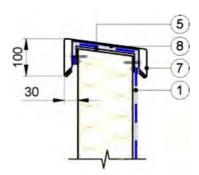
Примыкание к парапетной стене высотой менее 500 мм с использованием фартука (см. рис.13) Металлический отлив укладывается на крепежные элементы и крепится к парапету с помощью саморезов. Кровельный ковер заводится на отлив и приваривается к нему. Край примыкания промазывается жидким ПВХ.
